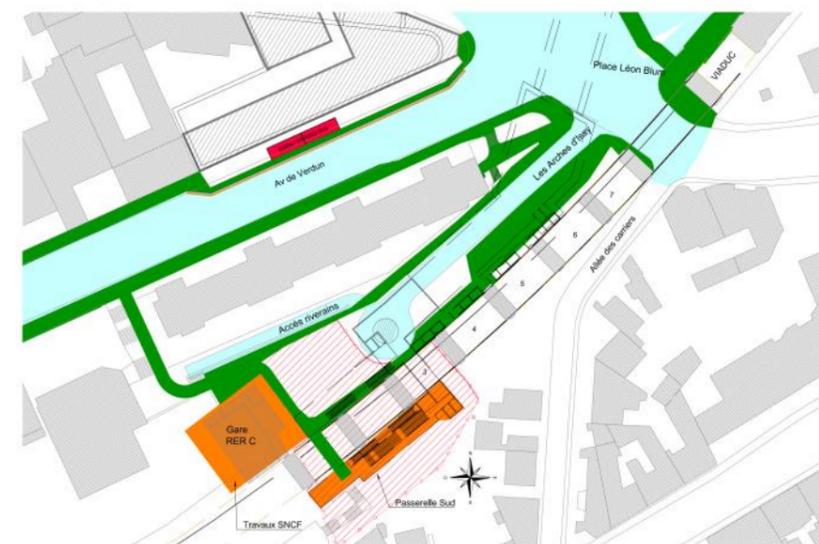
Gare d'Issy RER – plan d'emprise chantier
